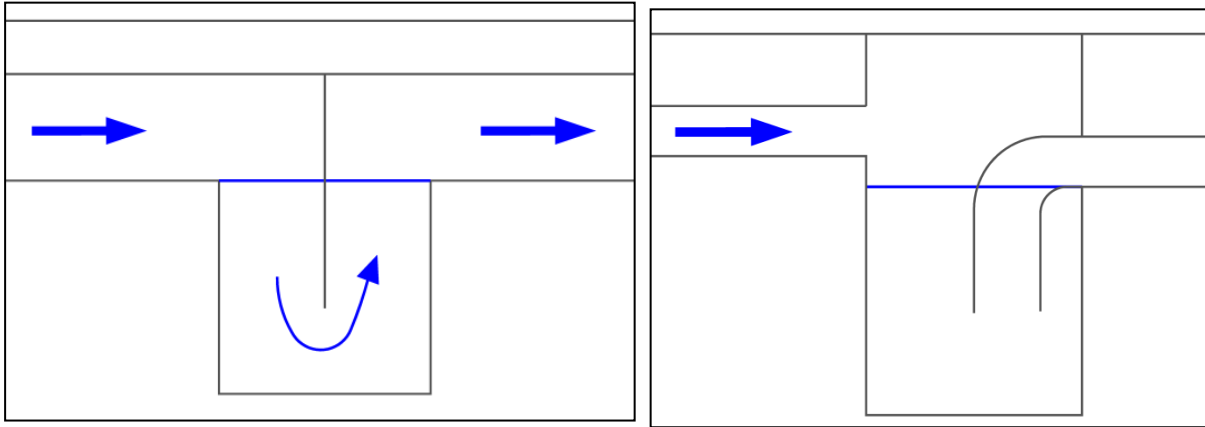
Schémas de principe de 2 exemples de zones de décantation (cloison siphonoïde et coude PVC)
